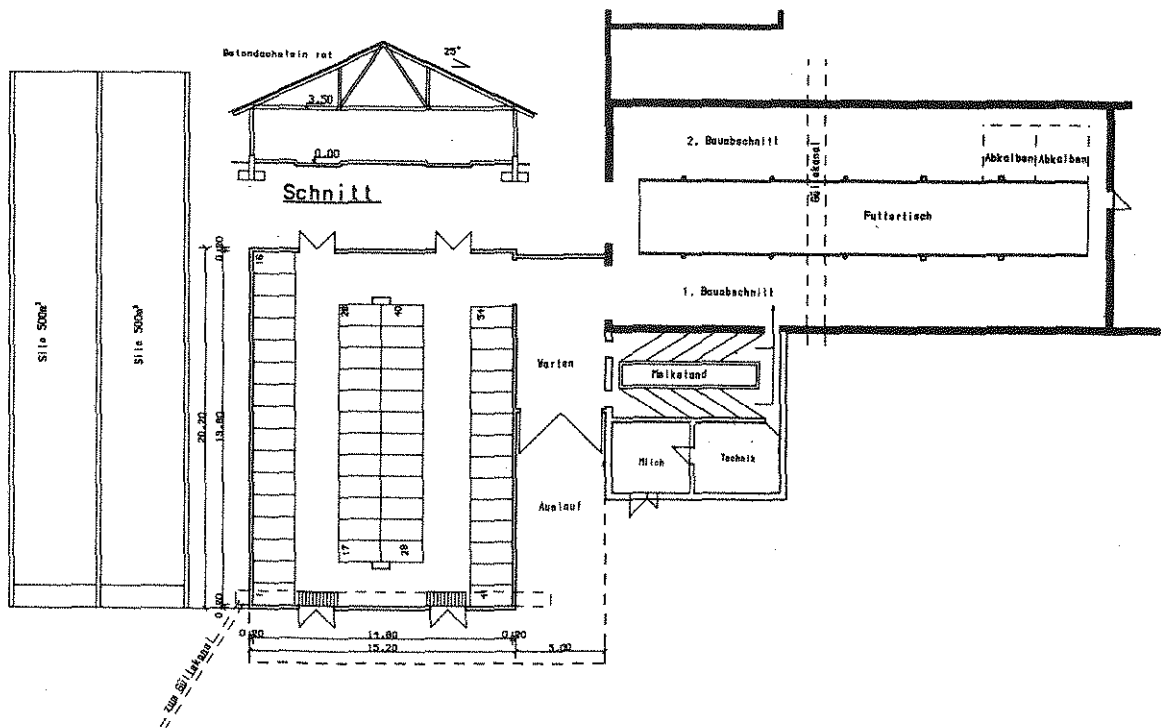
Umbau eines Stallgebäudes und Neubau einer Liegeboxenhalle
